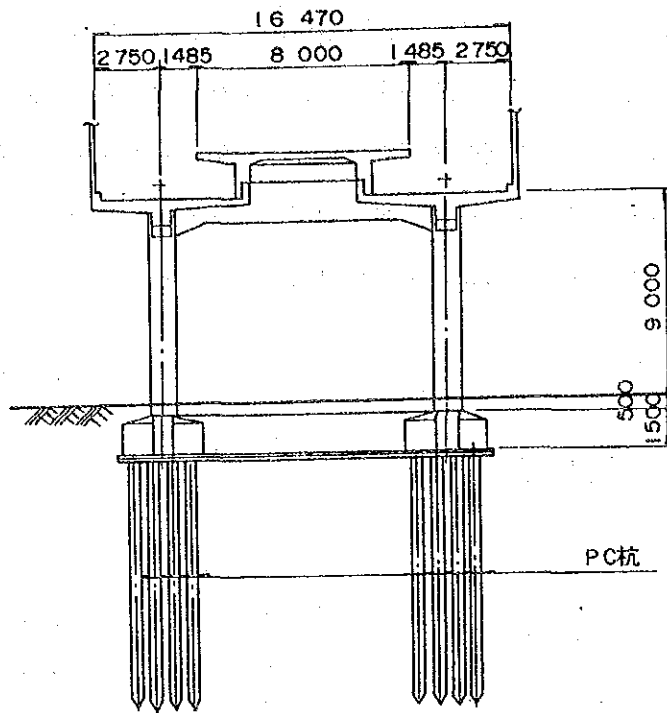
駅部高架橋（終端駅、島式ホーム）標準断面図
